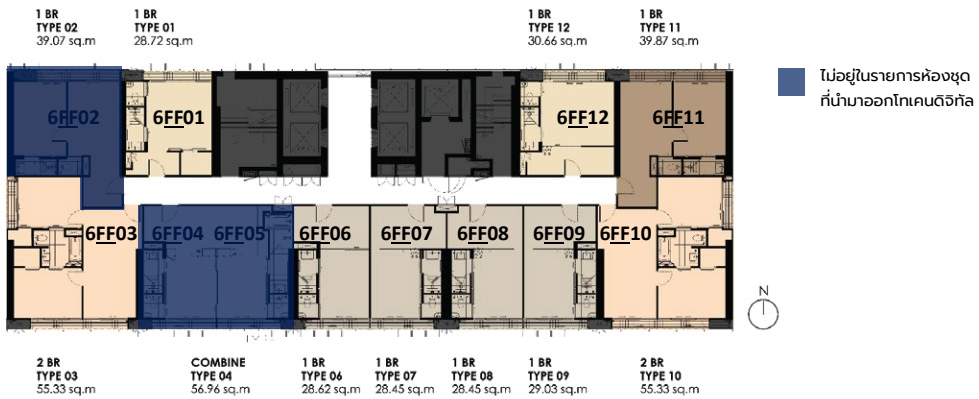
1 Floor Plan ของอาคาร 6
